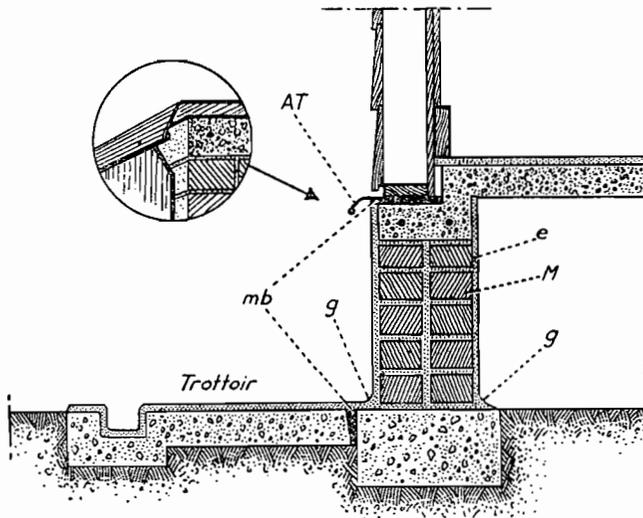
Construction en bois posée sur un soubassement en maçonnerie avec plancher en ciment armé.
